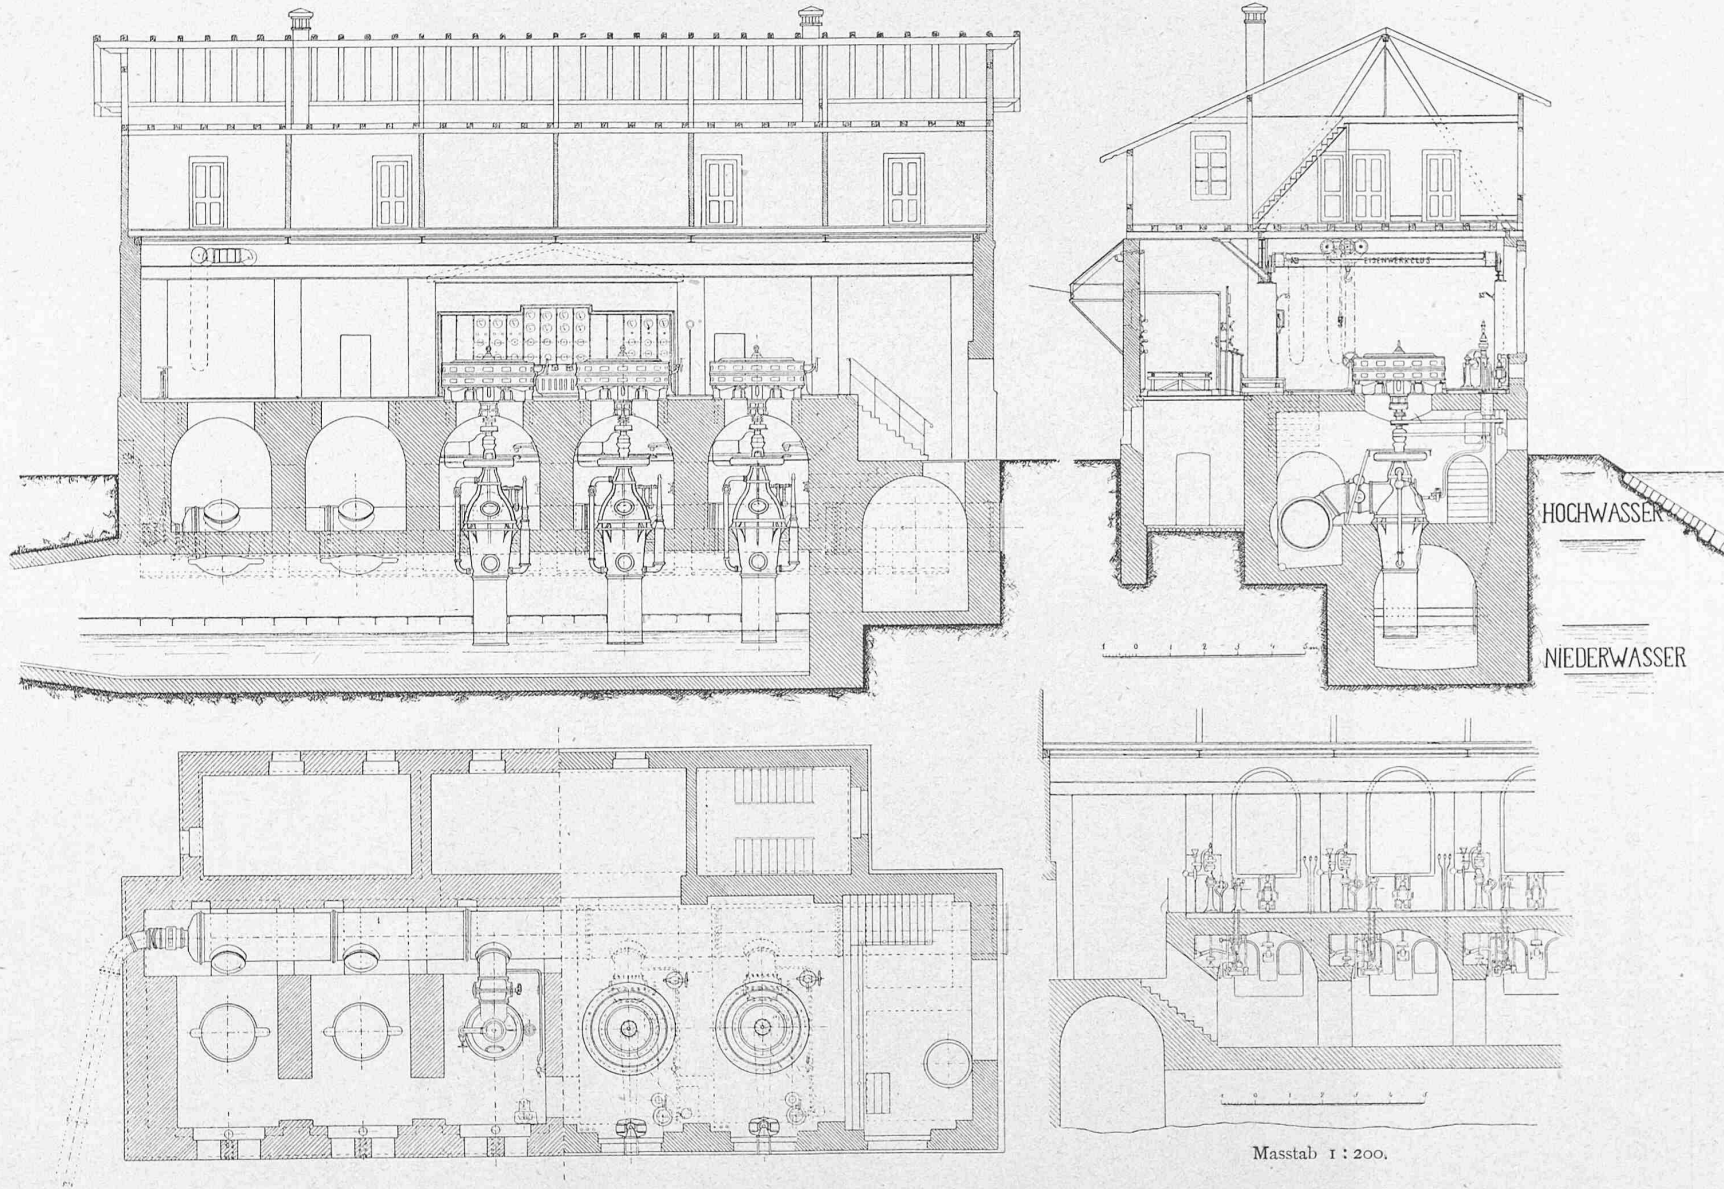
35. Schnitte und Grundriss des Maschinenhauses.
